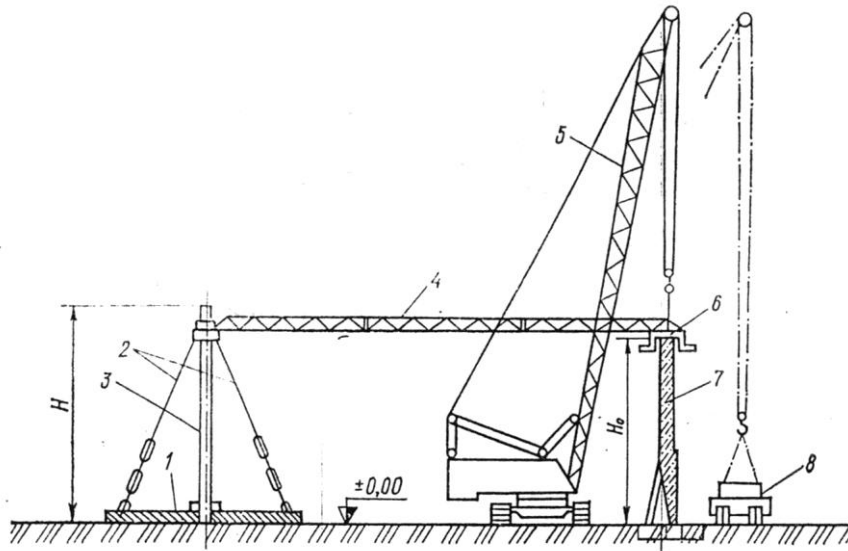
Монтаж залізобетонних панелей стін опускного колодязя за допомогою рухливого кондуктора: 1- фундамент щогли кондуктора; 2- розтяжка; 3- щогла; 4- поворотна розпірка; 5- монтажний кран; 6- опорна частина кондуктора; 7- залізобетонна панель; 8- панелевоз; R- внутрішній радіус колодязя, що відповідає радіусу кондуктора; H- висота кондуктора; H_0 - висота панелей.
